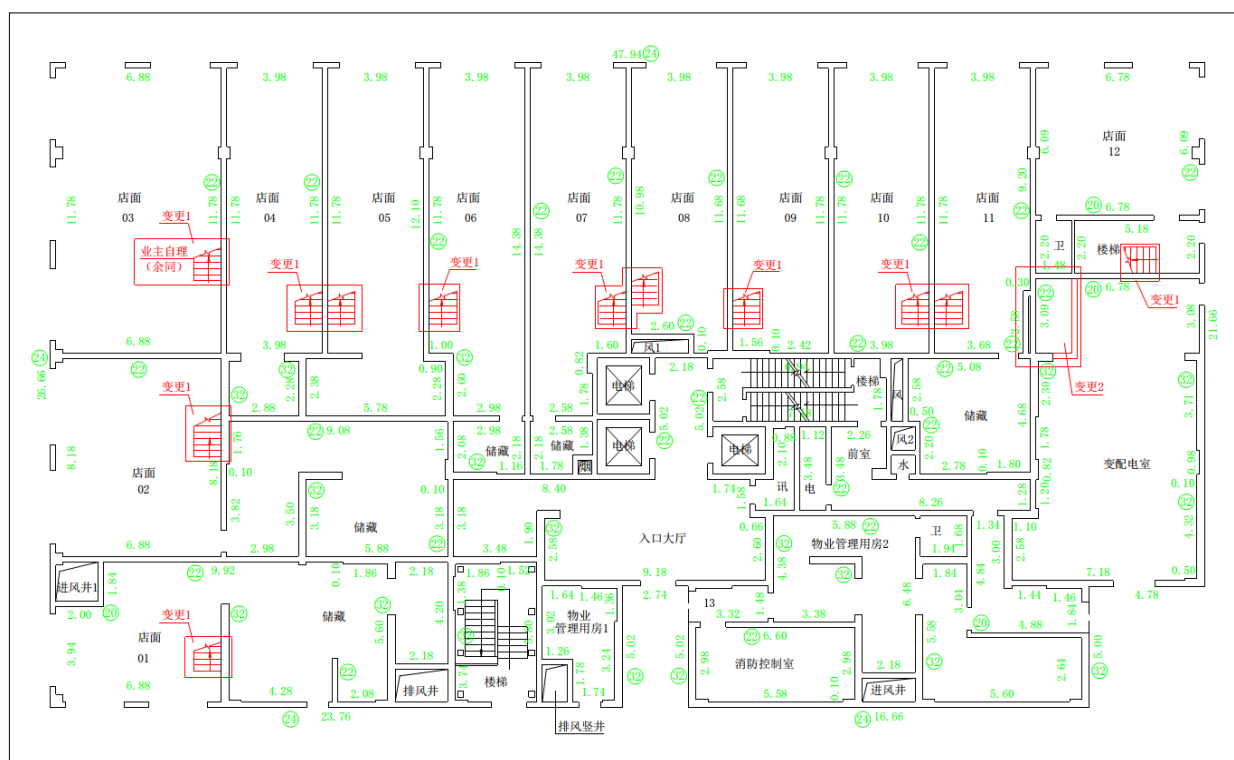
竣工分层平面图与规划许可不一致对照示意图局部放大图
